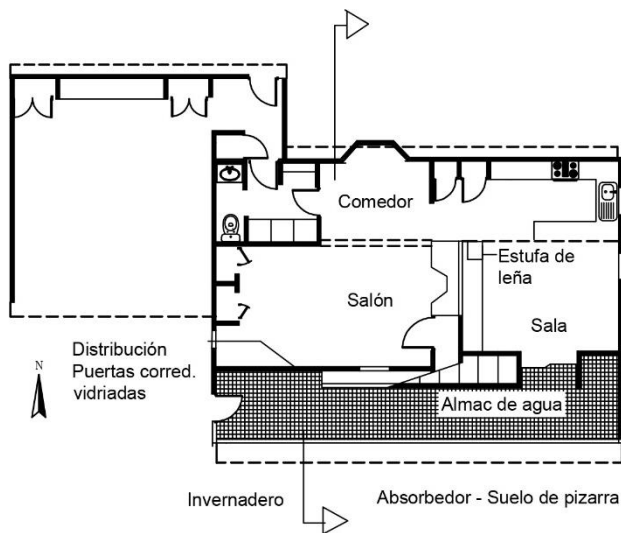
Vista en planta, Huntington. Elaboración propia, fuente: Mc Philips (1985)
